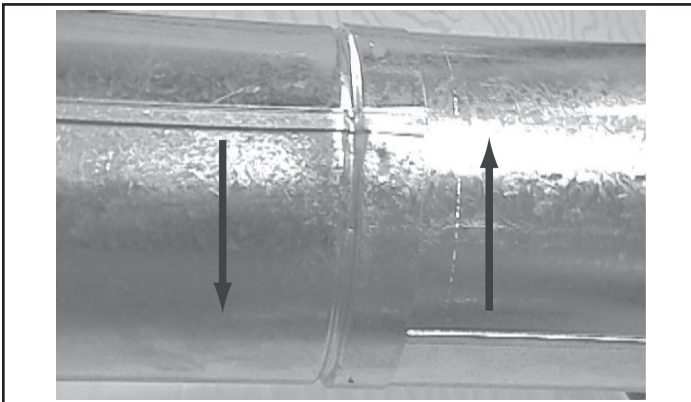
Tourner les cordons de soudure pour le démontage
